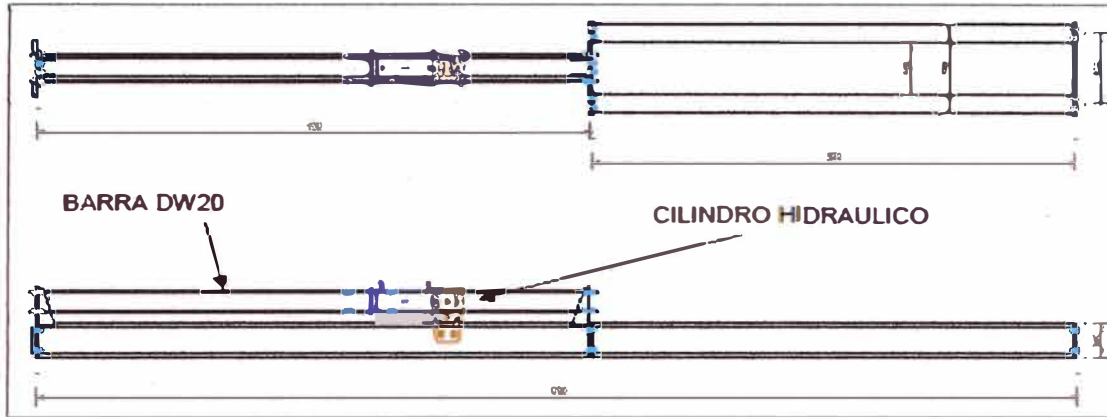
Planta y Elevación del Carril de Avance, con barra DW20 y Cilindro hidráulico.
